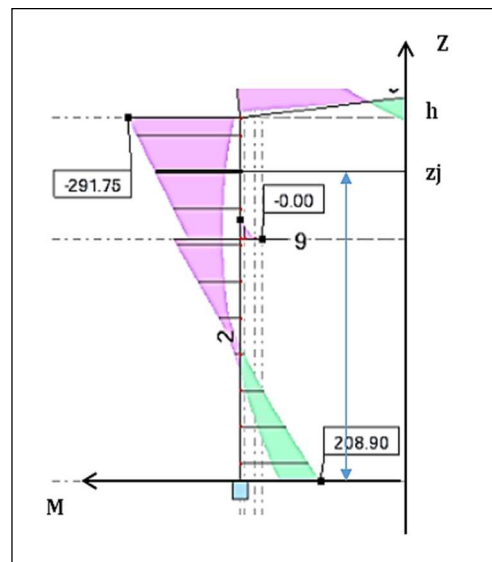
schéma statique du jarret de la traverse coté de poteau.
